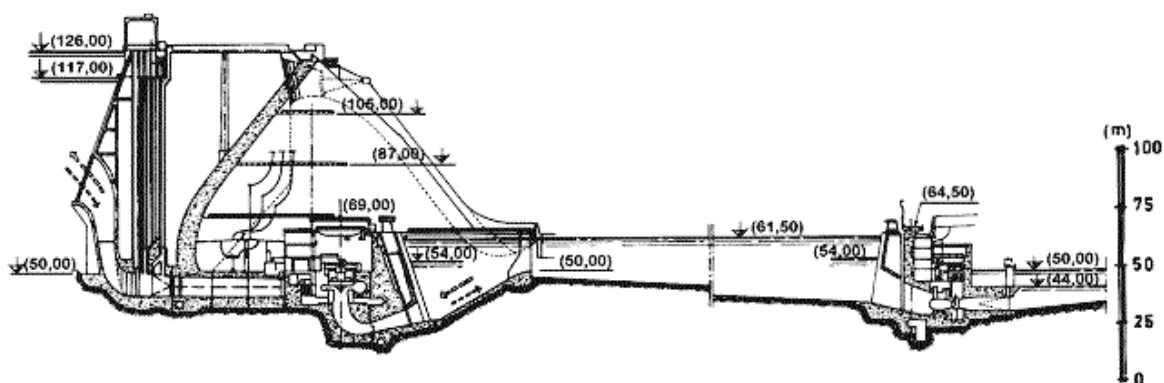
Corte longitudinal das barragens da Aguieira e da Raiva (Fonte: <http://cnpgeb.inag.pt>)
